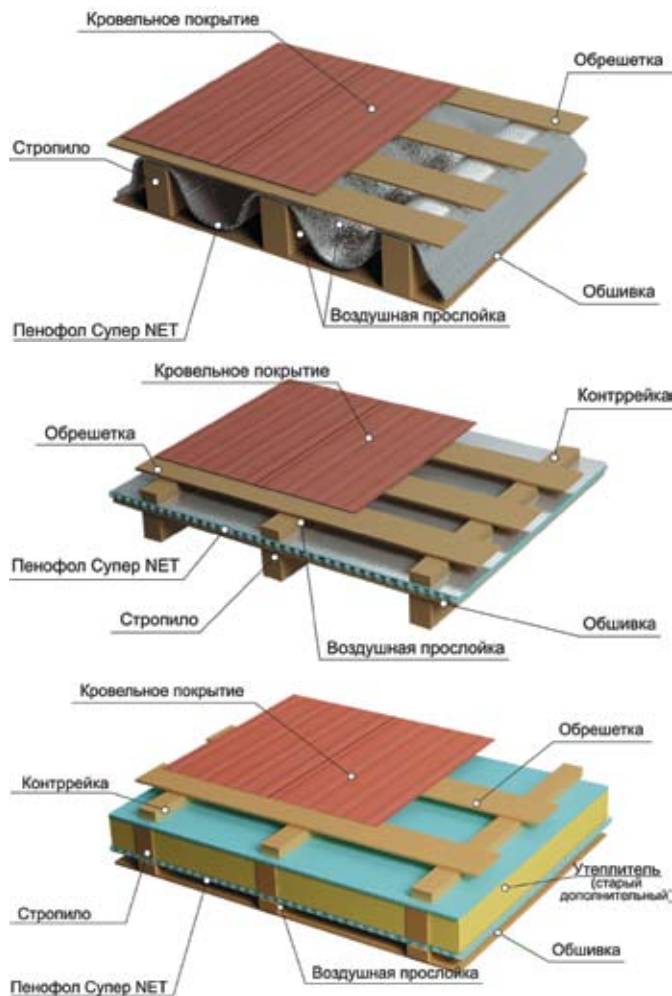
Примеры конструкции скатной кровли с применением отражательной теплоизоляции
